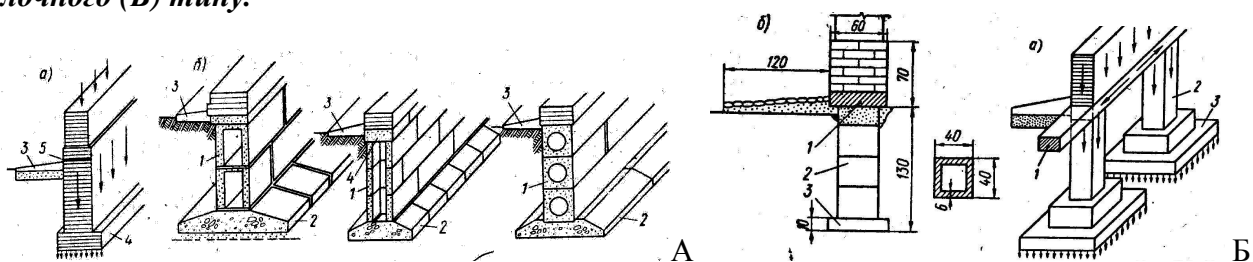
Стрічкові фундаменти (А): а – бутові й бутобетоні; б – зі збірних елементів; 1 – блоки фундаментів; 2 – подушка; 3 – підмостки; 4 – підошва; 5 – гідроізоляція. - Стовбчасті фундаменти (Б): а – для багатопверхових будівель; б – для малоповерхових будівель; 1 – фундаментні балки; 2 – стовп; 3 – подушка.
